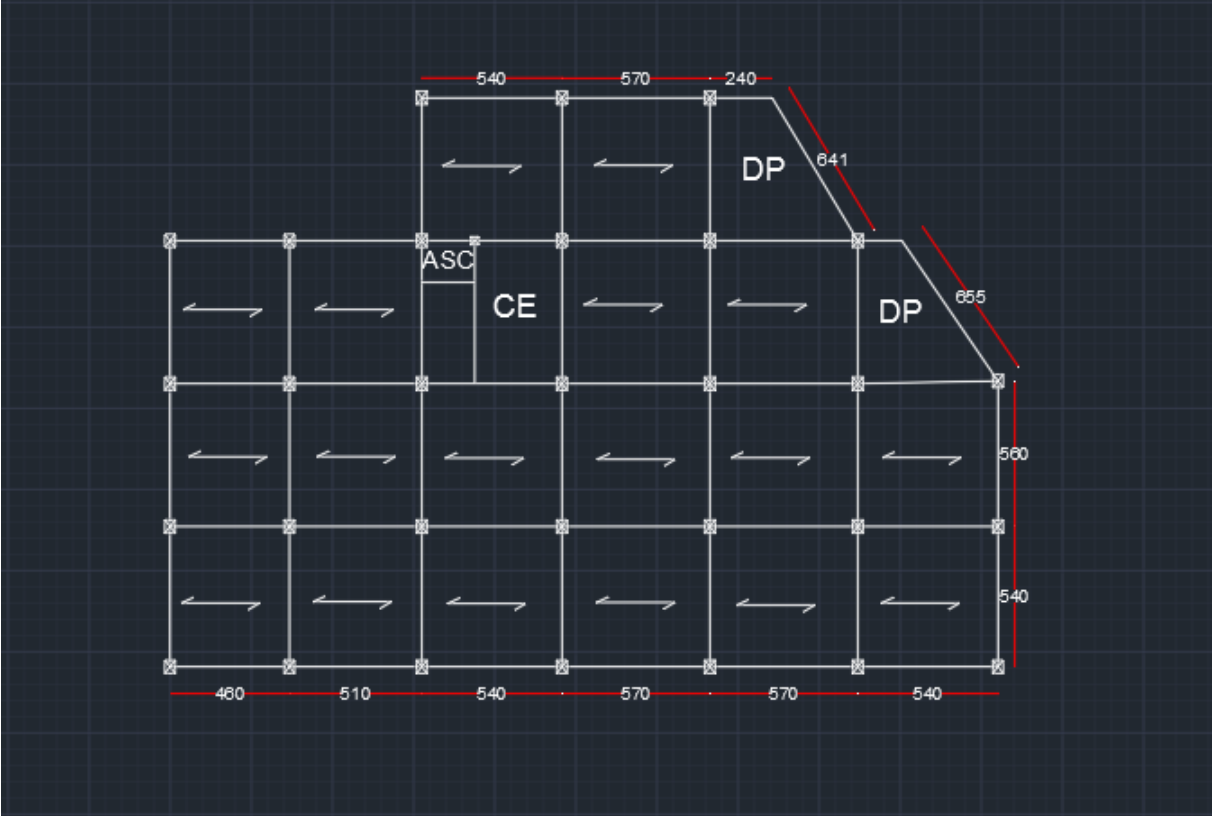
dispositions des poutrelles et positions des dalles pleines (étage 1 et 2).
